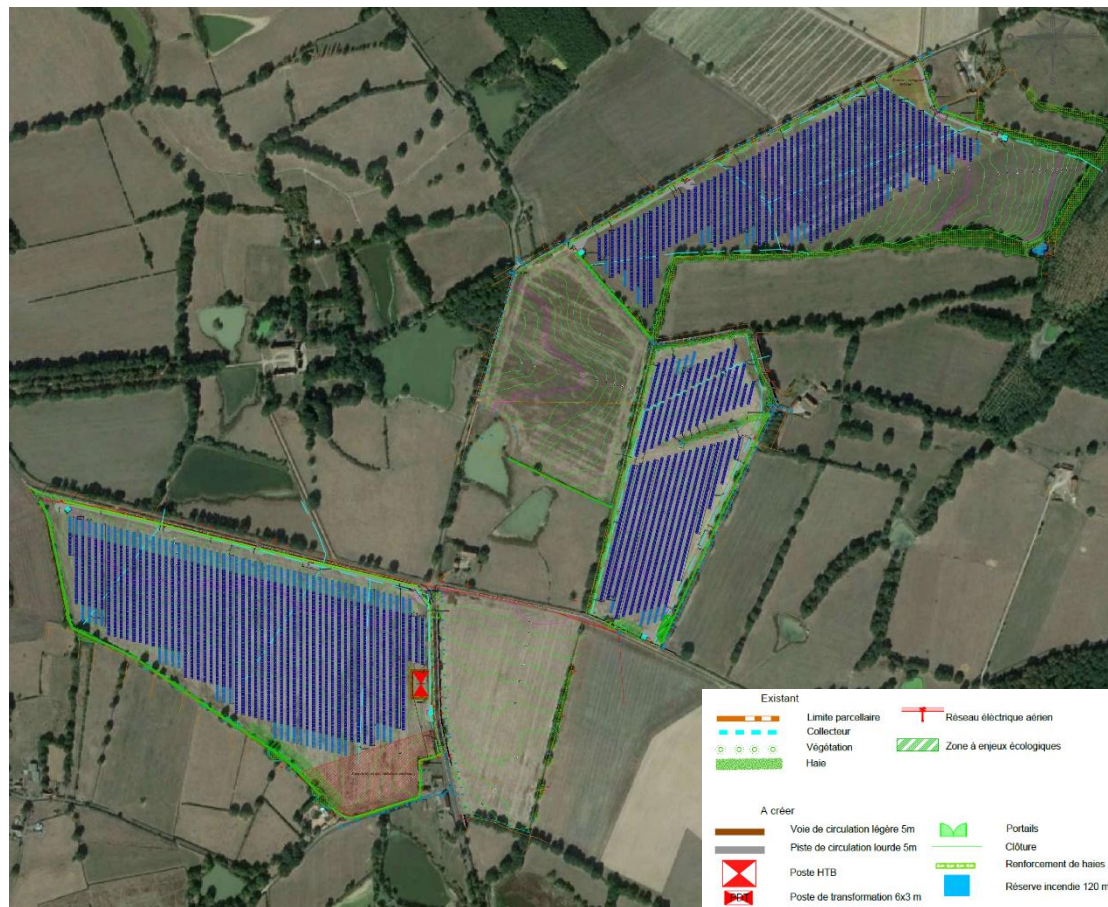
Plan d'implantation de la variante finale (source : SOG SOLAR)
